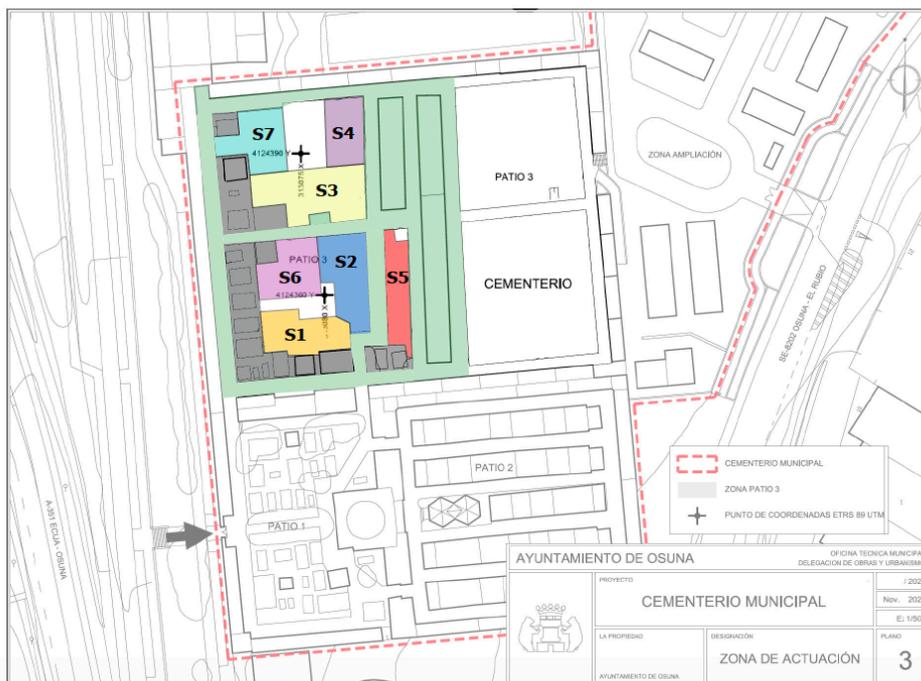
Detalle del cementerio en su configuración histórica, con indicación de sectores intervenidos. Elaboración propia a partir de plano del Ayuntamiento de Osuna.
